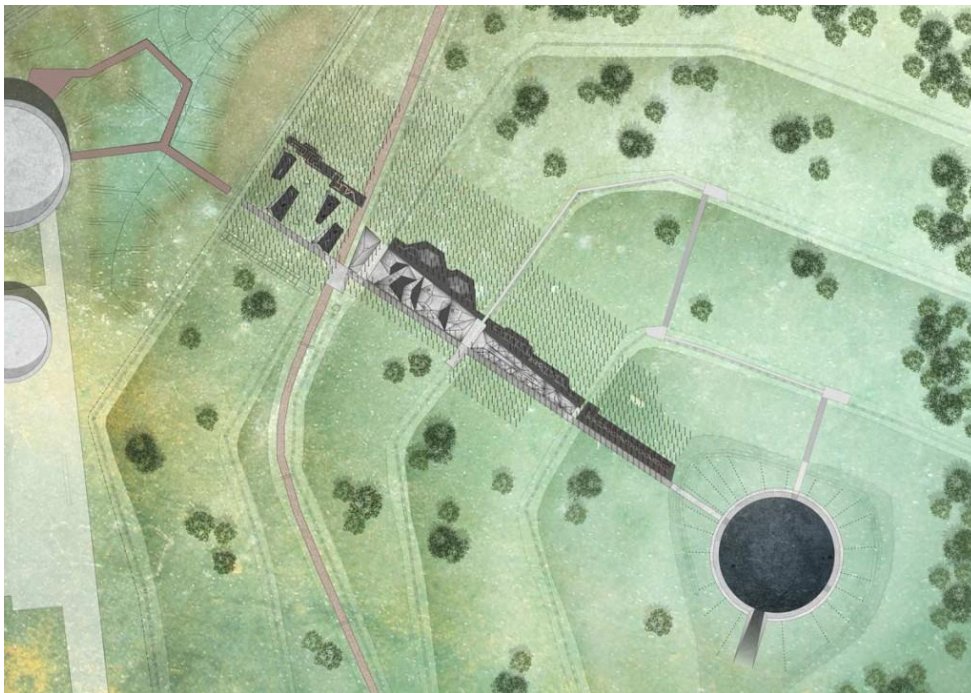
planta baixa do parque (fonte: <http://landezine.com/index.php/2016/10/play-landscape-be-mine-beringen-be-by-carve-and-omgeving/>)
